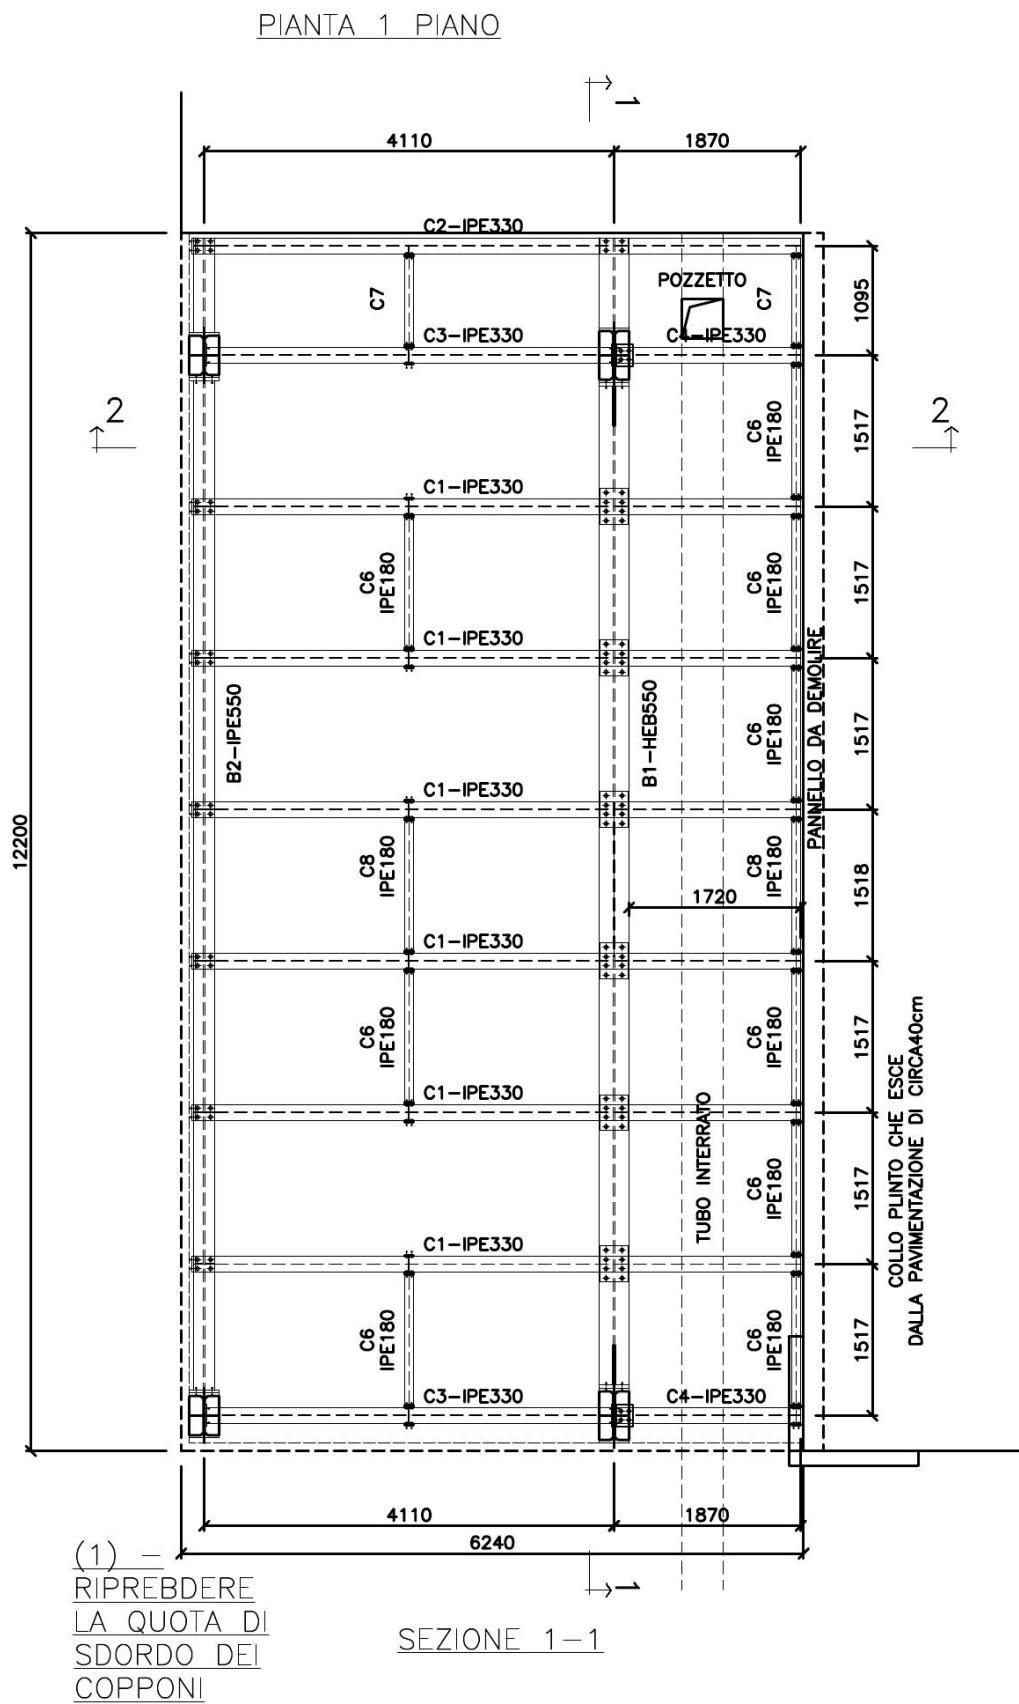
Particolare di A.2009.a.us.T02 - Progetto della struttura metallica - Pianta piano primo
